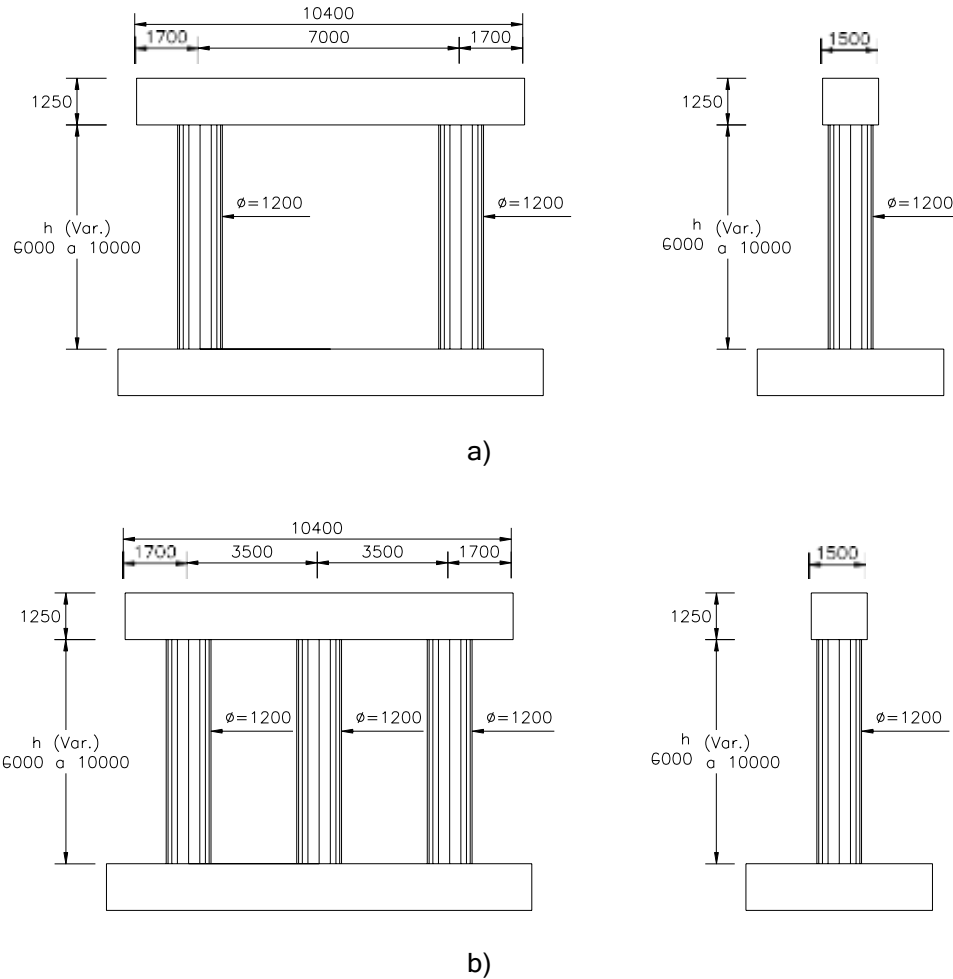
Elevación y sección típica de la subestructura. a) Tipo I - 2 columnas. b) Tipo II - 3 columnas
